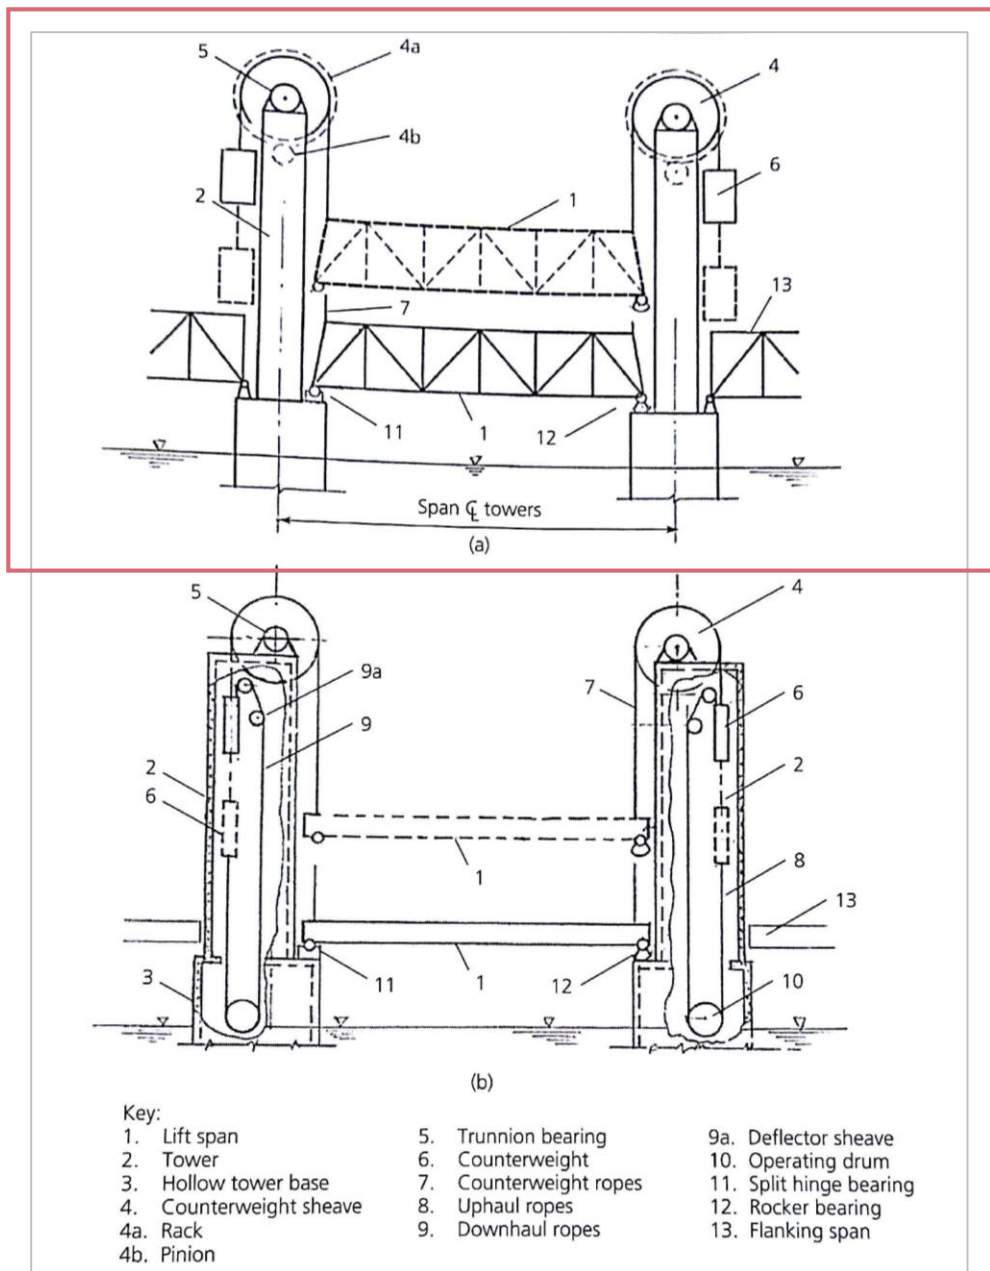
11. (a) "Tower drive". (b) "Tower base drive". [34]
